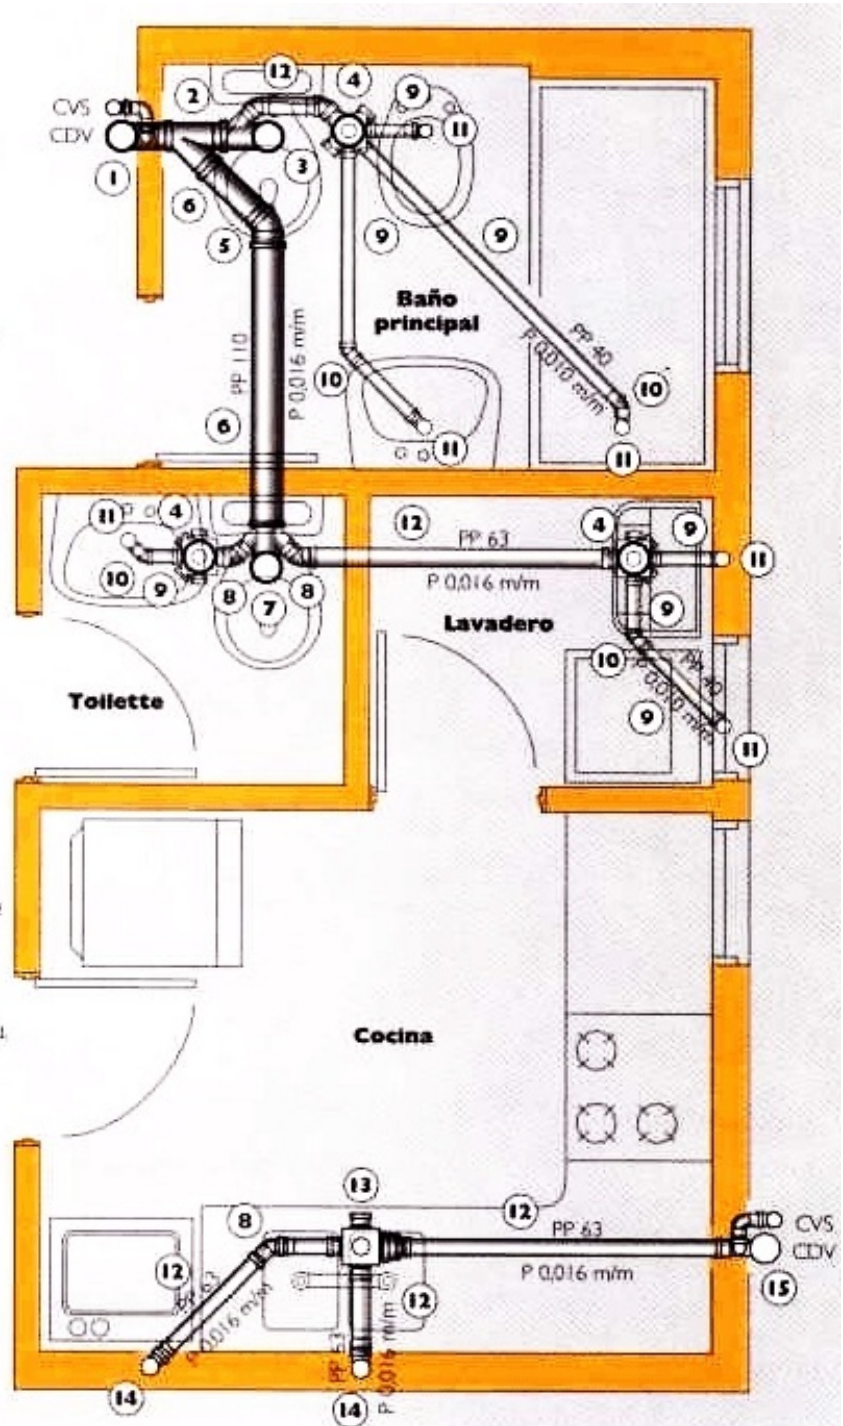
Ejemplo en planta de un núcleo sanitario para departamentos con cañerías de polipropileno.
